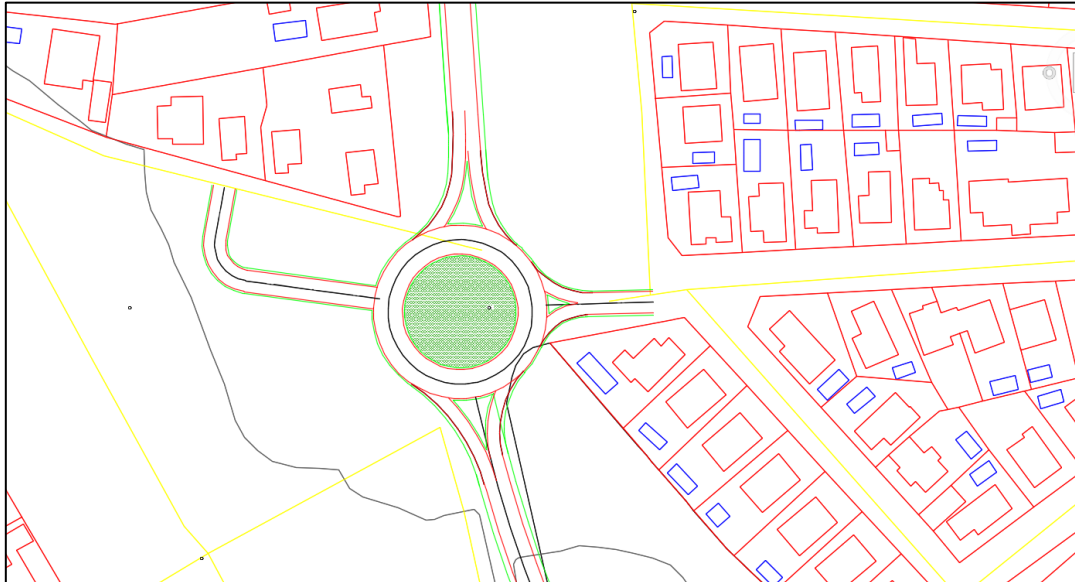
Intersección PK 2+730. Glorieta propuesta
